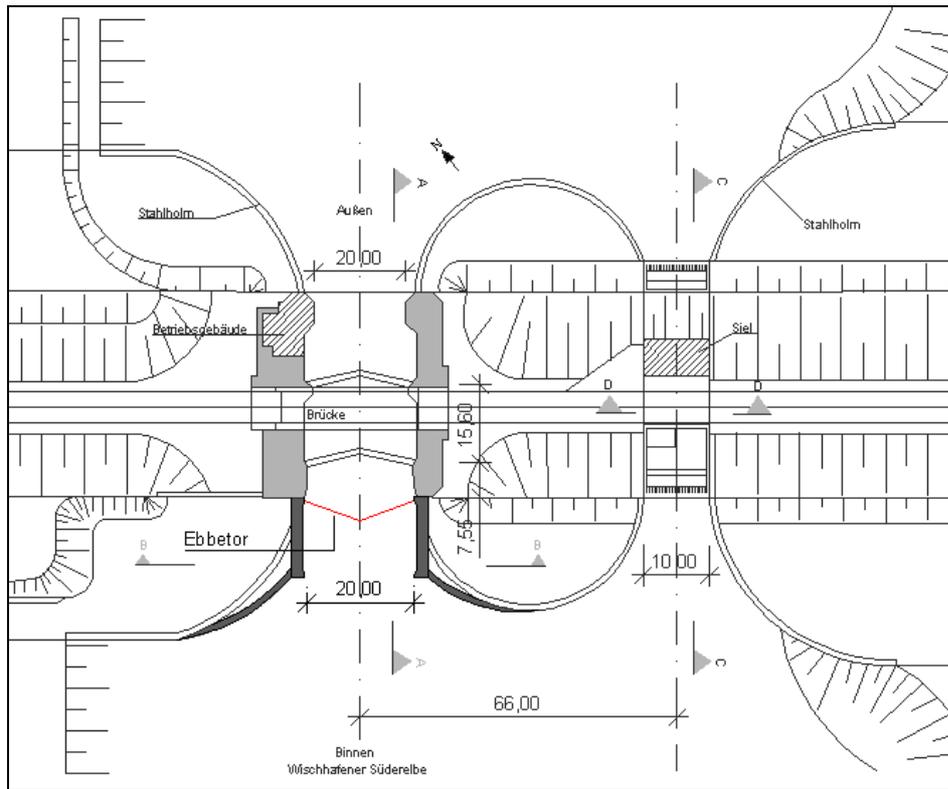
Variante 3.1: Ebbetor Grundriss Wischhafener Sperrwerk
